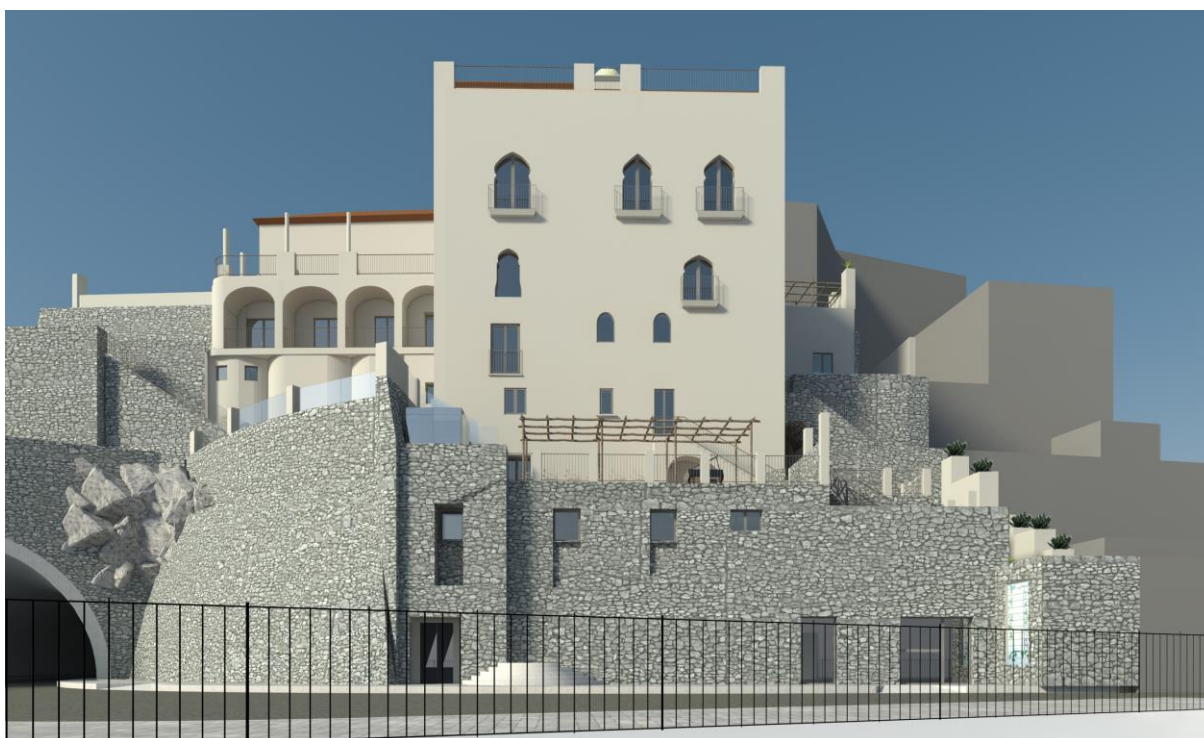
Progetto architettonico: Foto Render Prospetto Est
